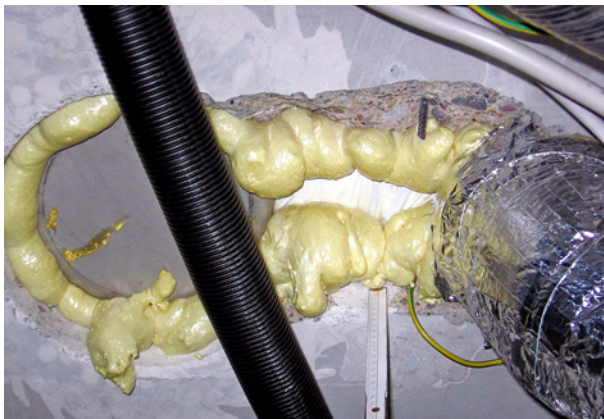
■ Polyurethanschaum zwischen dem Deckendurchbruch und dem Ablaufkörper
